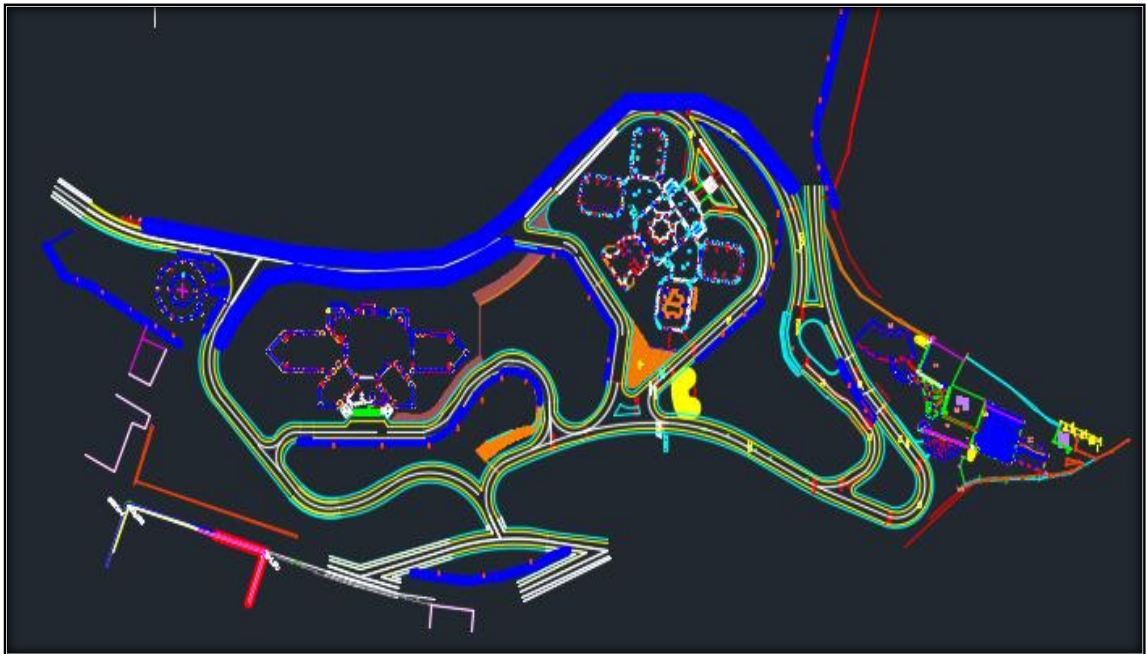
L'emplacement des murs de soutènement dans le projet, fait par AUTOCAD.
